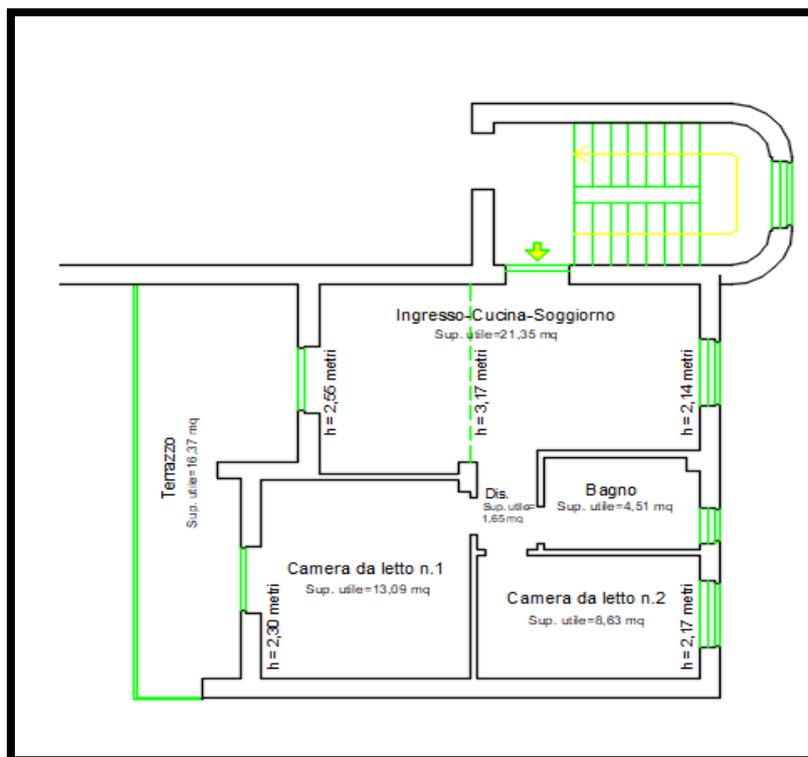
Rilievo appartamento part. 698 sub 33 – Piano terzo
